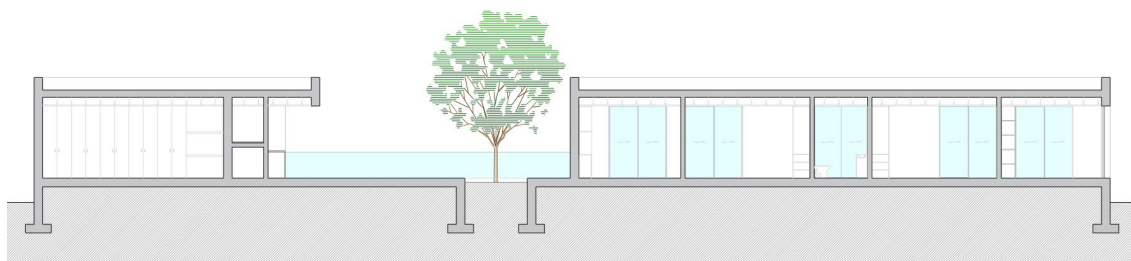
Corte esquemático - representação das portas-janelas na fachada leste.
